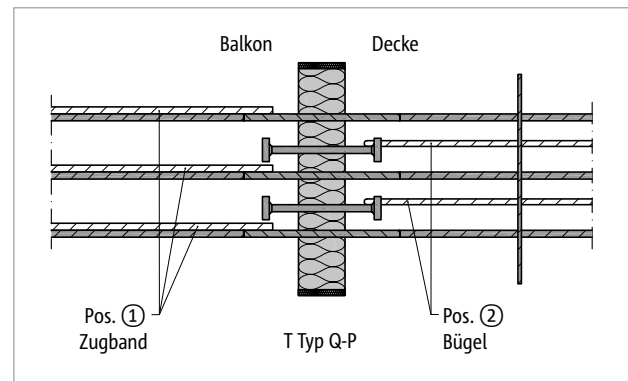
Schöck Isokorb® T Typ QP: Detail 1; Bewehrungsanschluss Zugband
